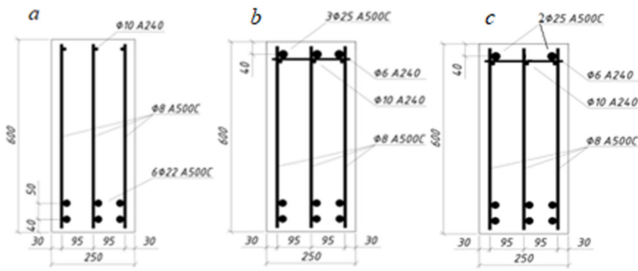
/ Fig 8. Армирование ригеля рамы консоли водосброса: а – в нижней части, полученное традиционными методами и расчетами в ПК «ЛИРА-САПР 2021»; б – на опорах сверху, полученное традиционными методами; с – на опорах сверху, полученное в ПК «ЛИРА-САПР 2021» / Reinforcement of the crossbar of the spillway console frame: а – in the lower part, obtained by traditional methods and calculations in the LIRA-SAPR 2021 software; б – on supports from above, obtained by traditional methods; с – on supports from above, obtained in the LIRA-SAPR 2021 PC
